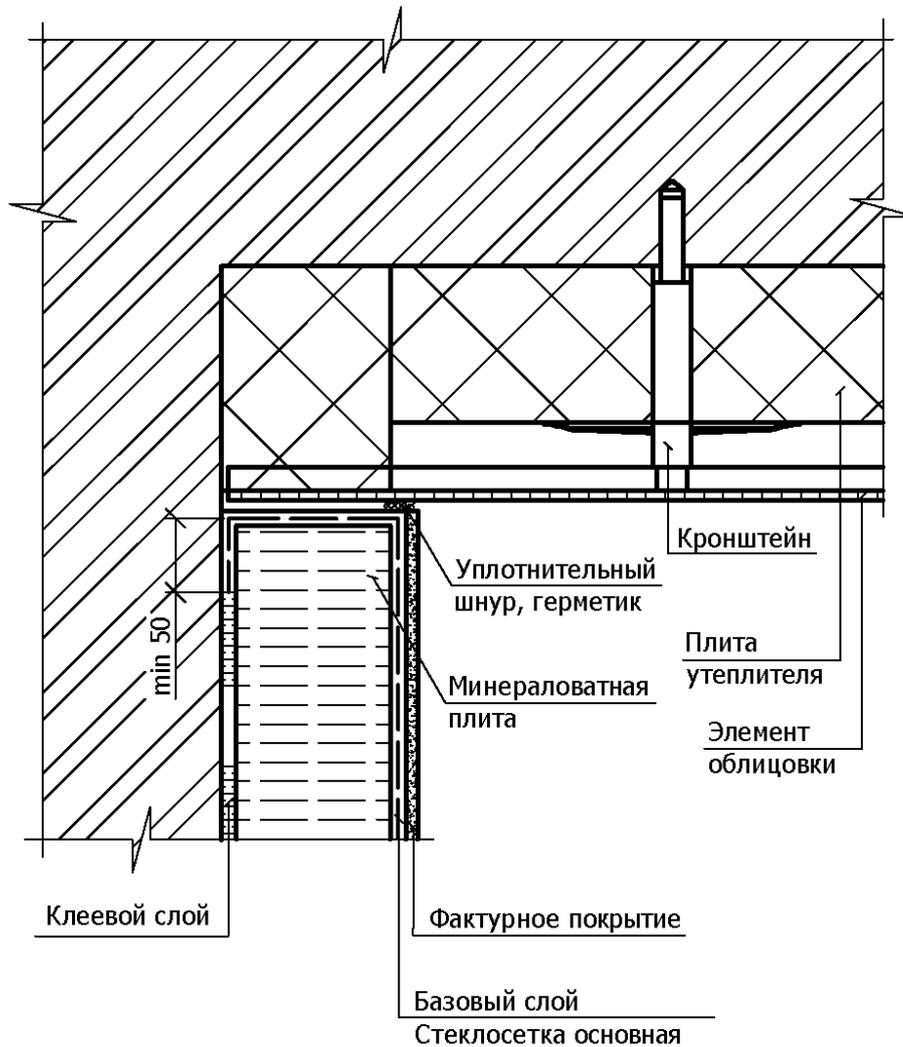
М Примыкание системы к вентилируемому фасаду на внутренних углах (вариант 2) ЛАЭС-М
